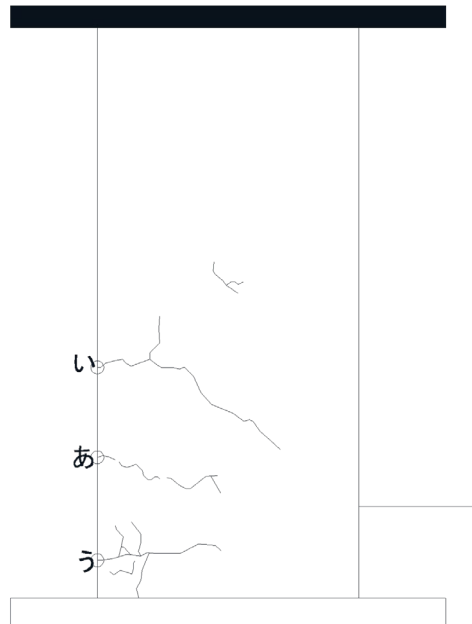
柱ひび割れ幅測定位置(試験体 D-2 正載荷)
